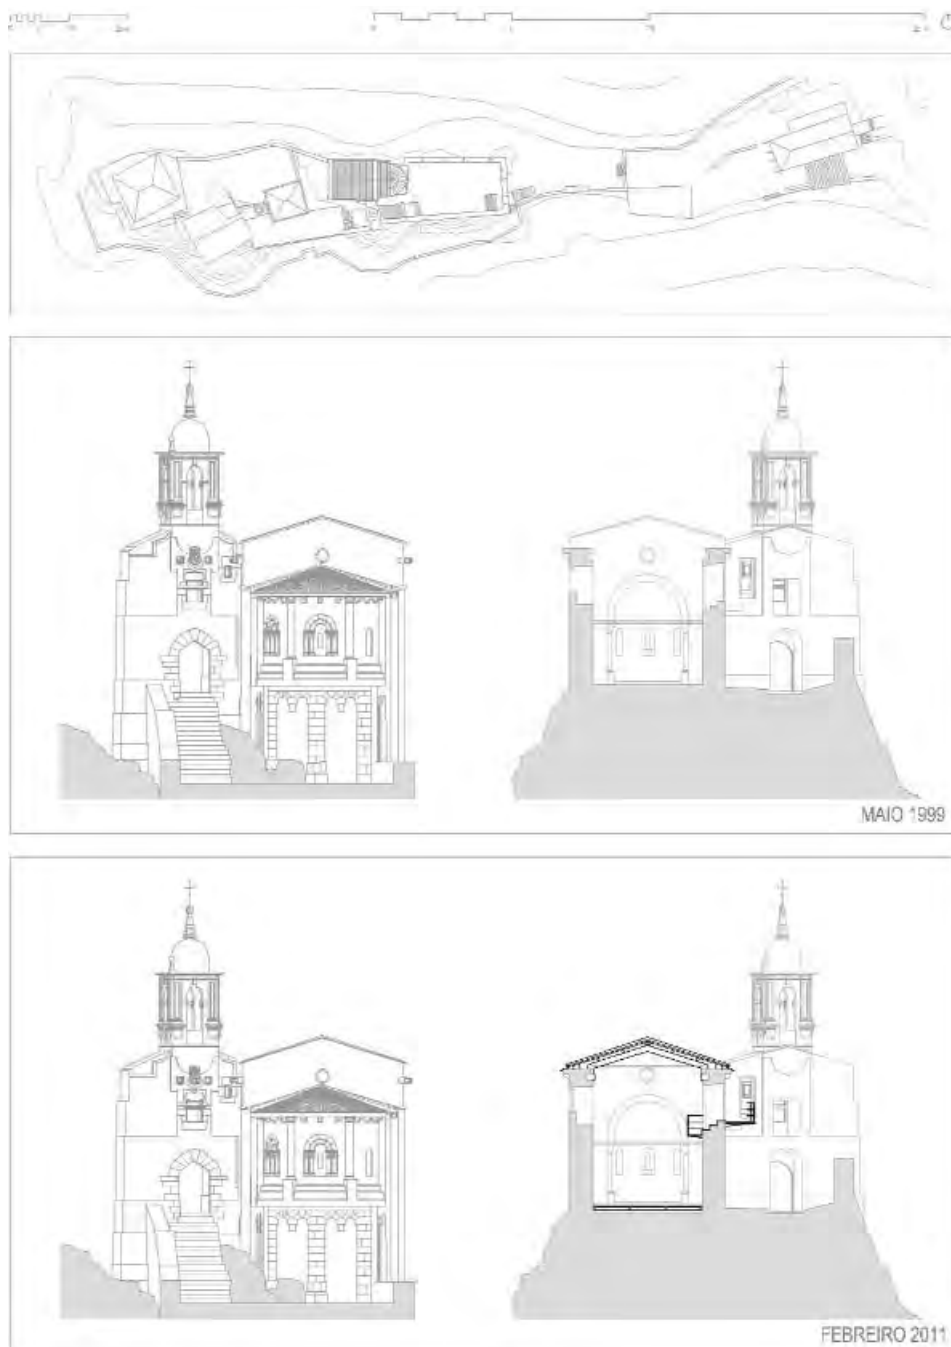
CAAVEIRO. Alzado leste e sección transversal da Igrexa de Santa Isabel.
